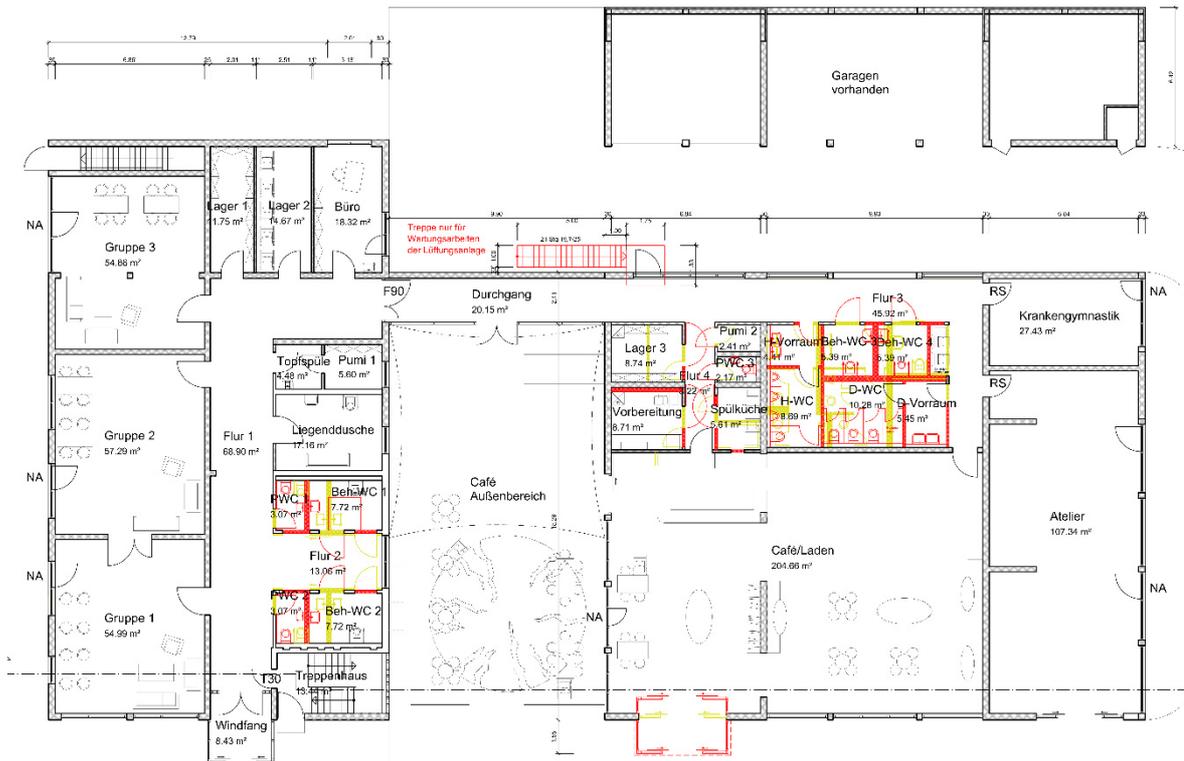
Kulturpark Erdgeschoss Grundriss
